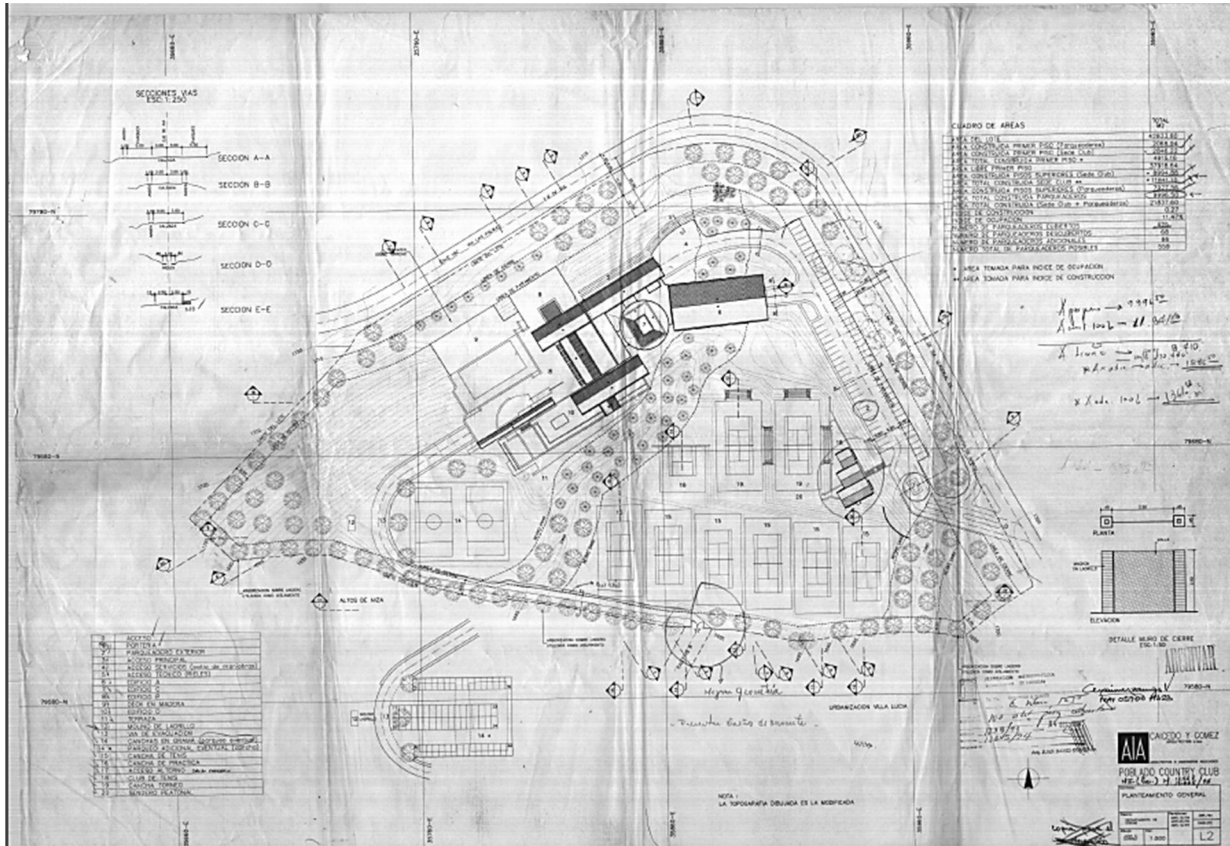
Plano proyecto aprobado - Club Campestre El Rosal
